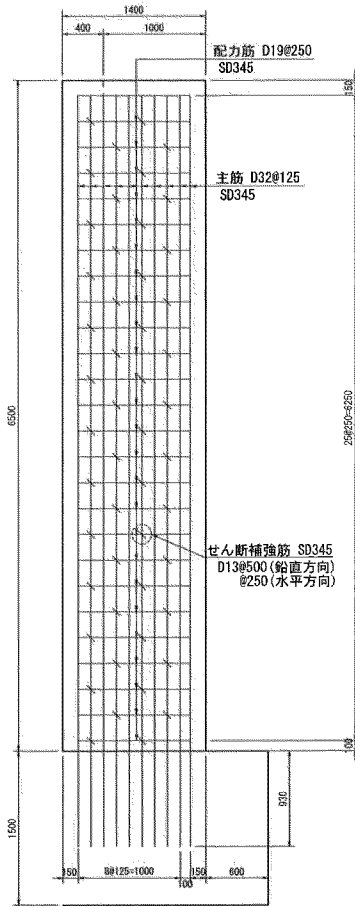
防波扉（荷揚場南）の受枠（RC支柱）の構造概要（平面図）
